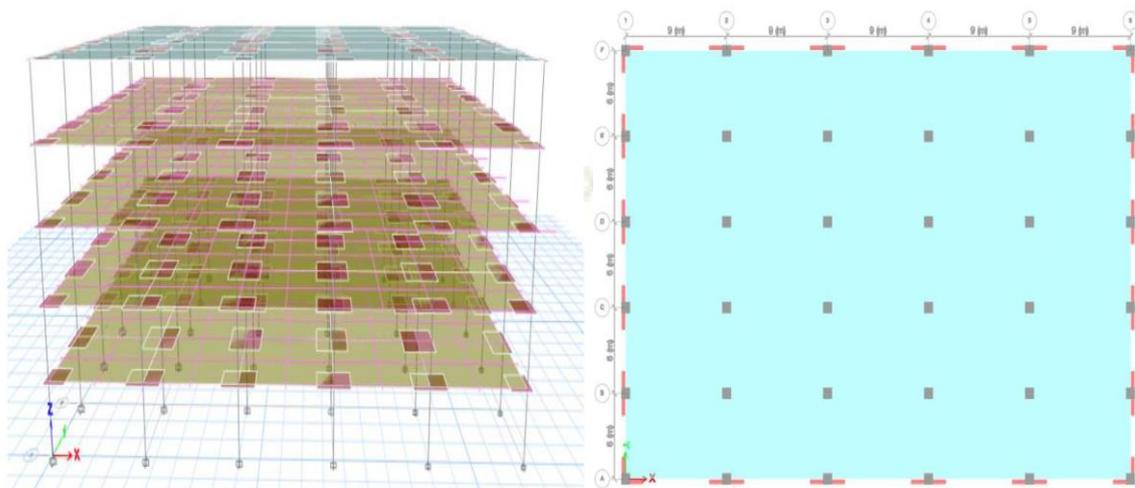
Denah lantai 1 dan lantai 2 Pasar Johar
